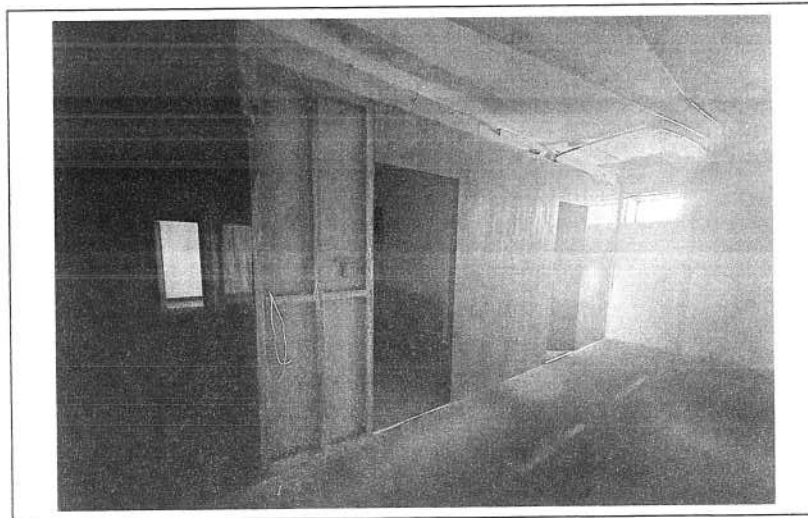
IMAGEN . MUROS DE DRYWALL EXISTENTES CON ACABADO DE LISTONES DE MADERA
